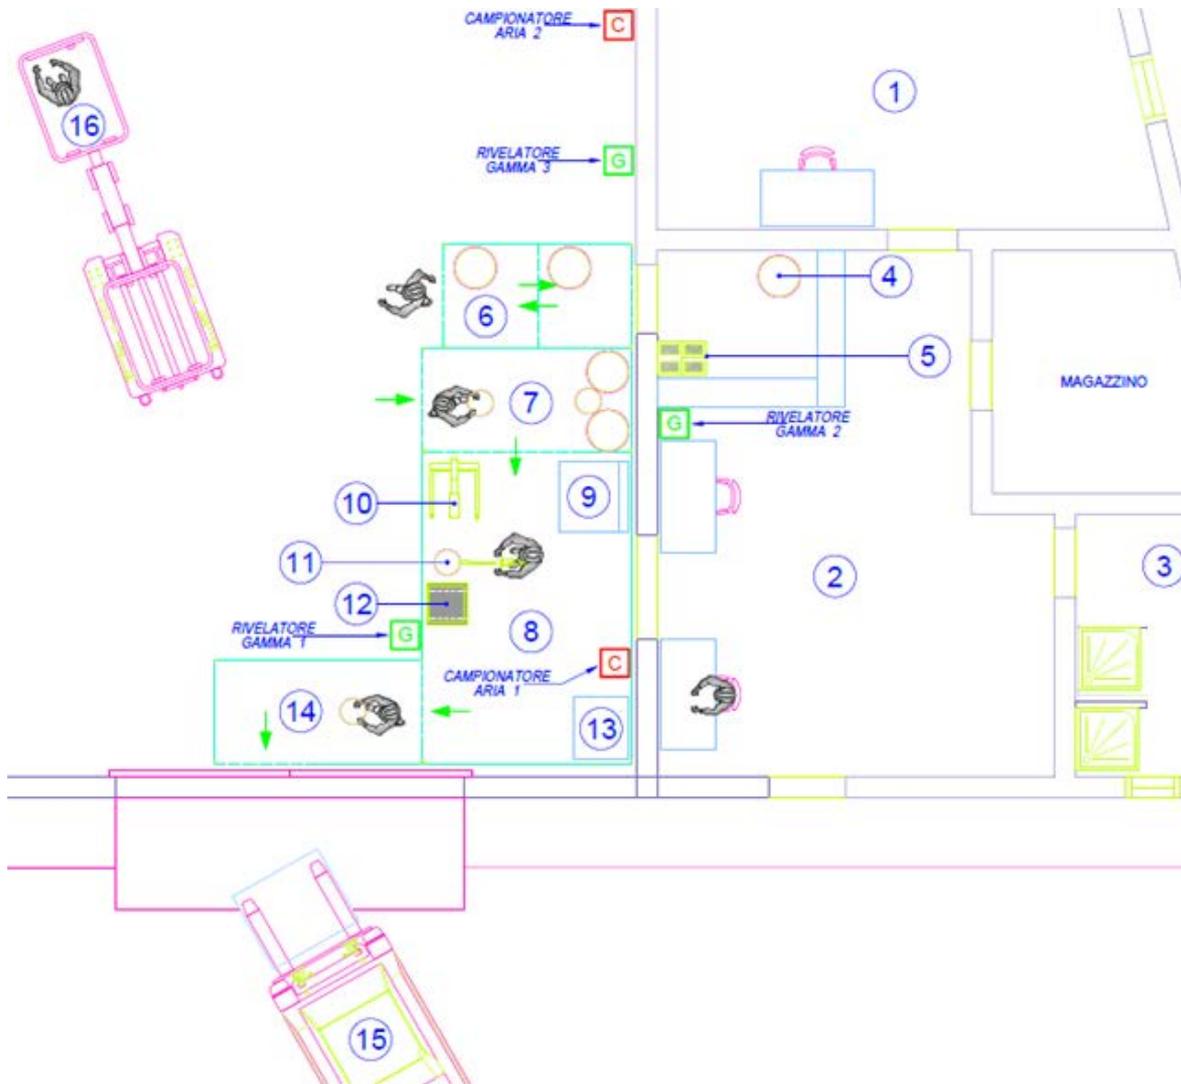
Planimetria con indicazione delle aree di lavoro da predisporre e da utilizzare durante le attività di bonifica
